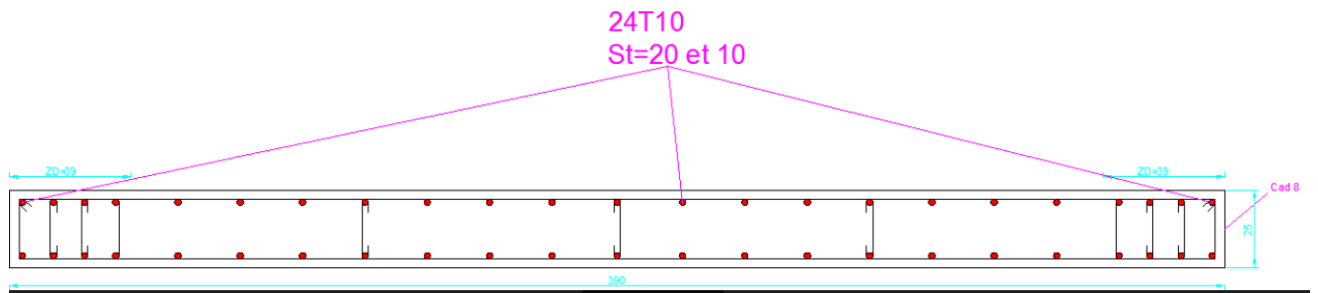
Schéma d'armature de trumeau T coupe A-A
